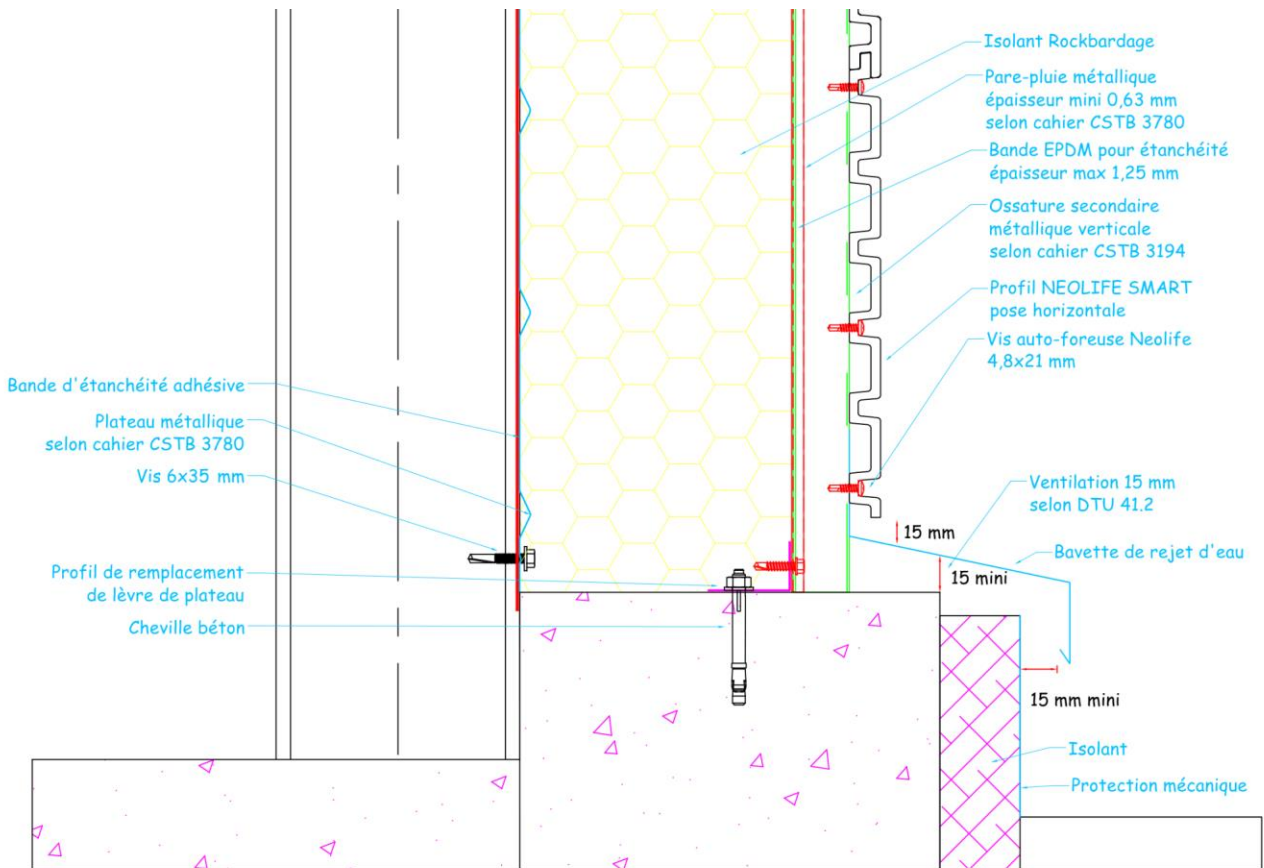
Fractionnement d'ossature avec plancher (coupe verticale)
